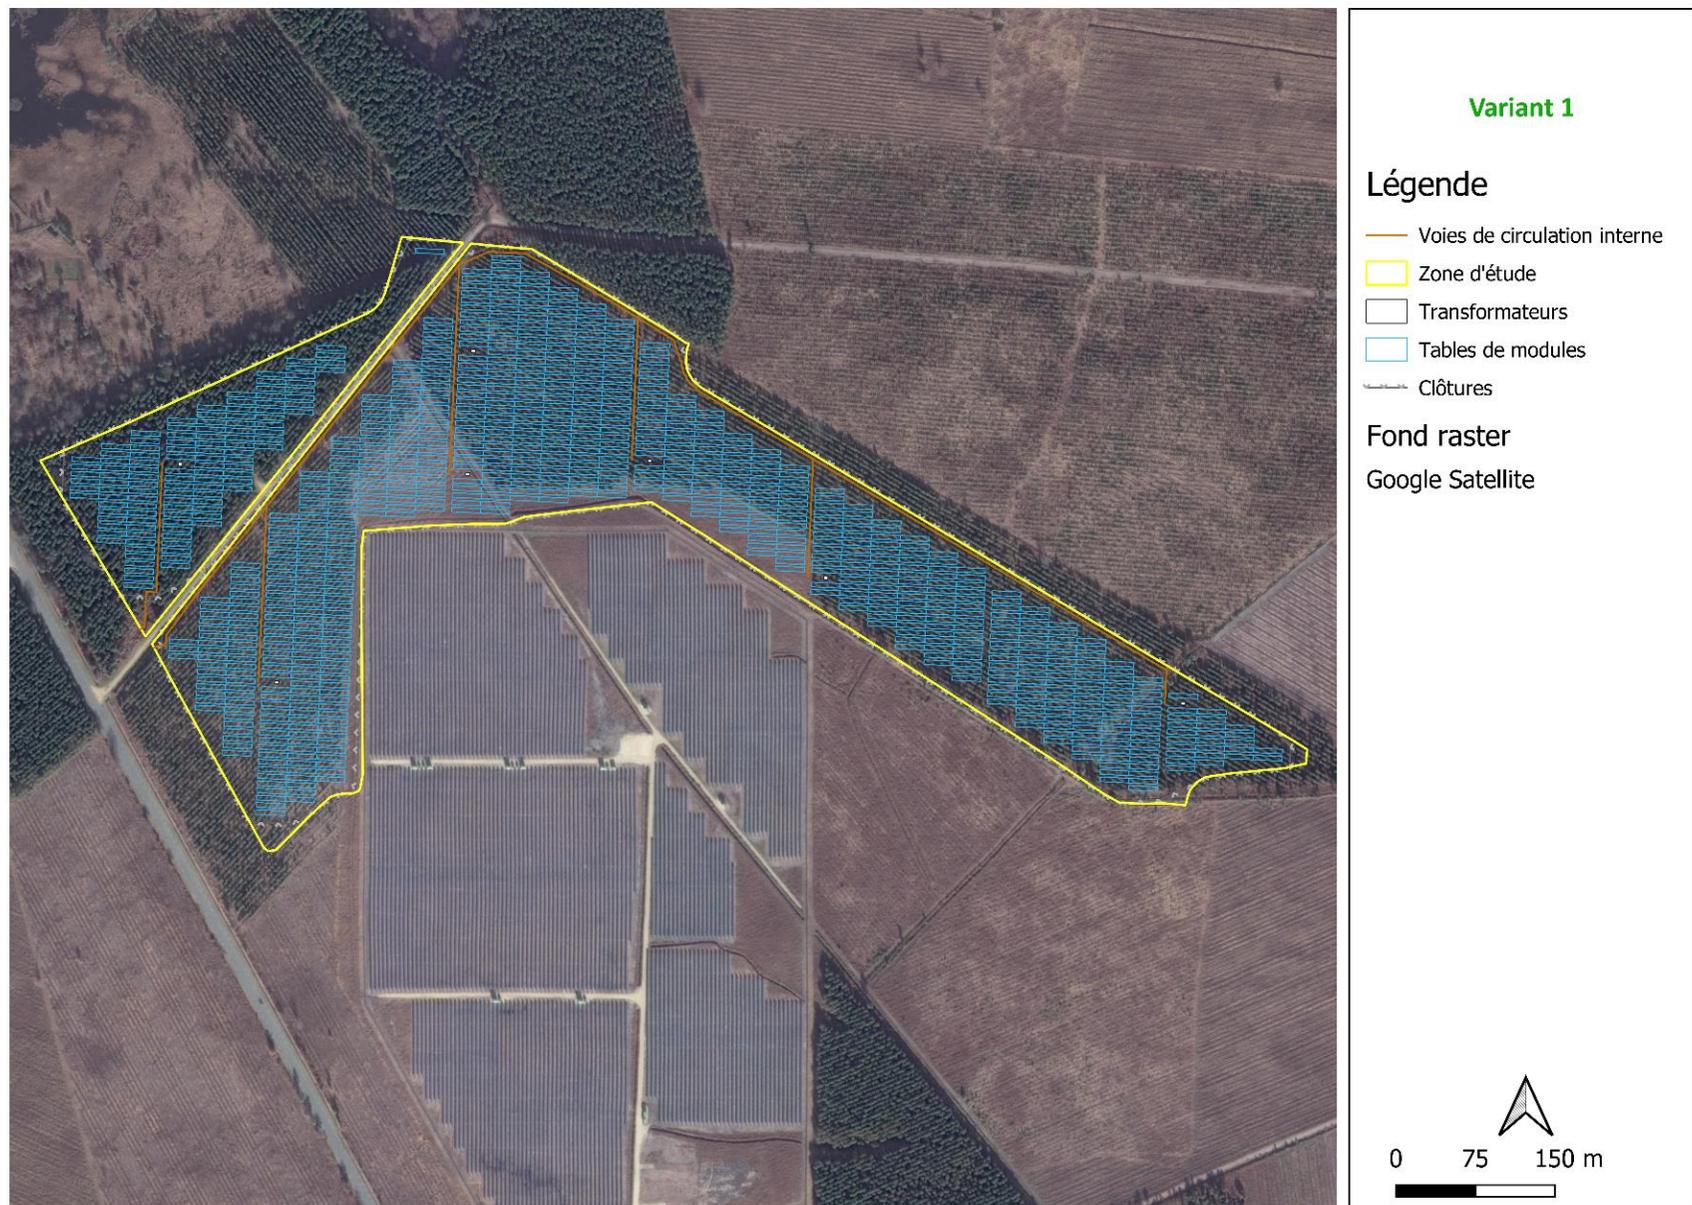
Variante 1 du plan masse du projet de parc photovoltaïque
